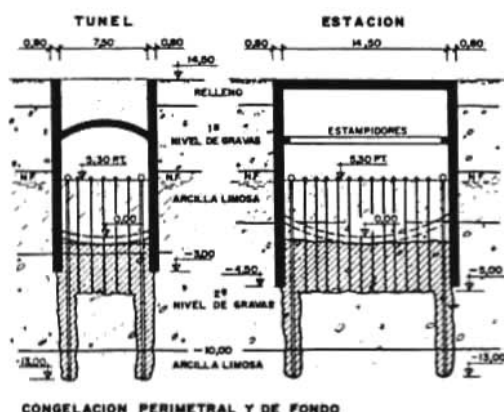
Congelación perimetral más tapón de fondo con suelo congelado
